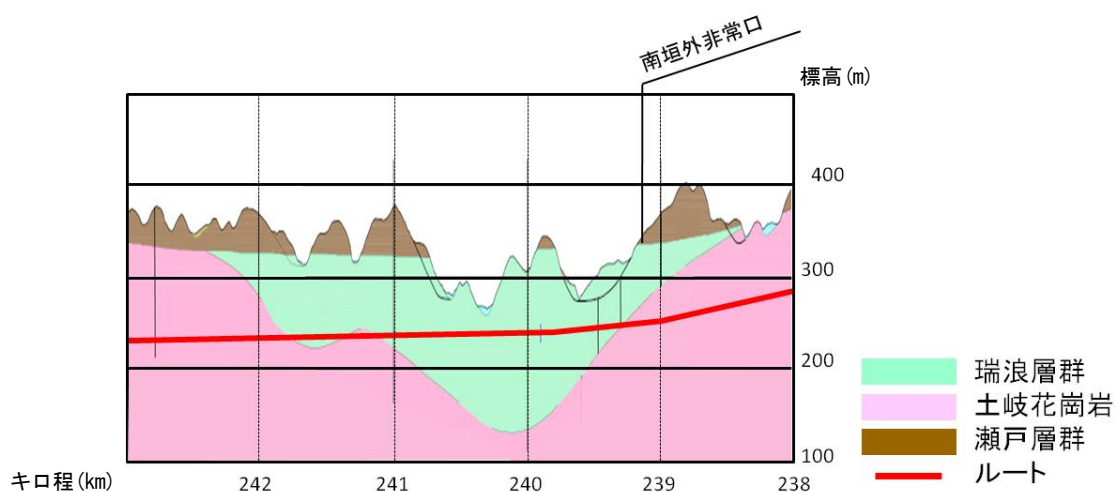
月吉鉱床北側の約 3km 区間の地質縦断面図
